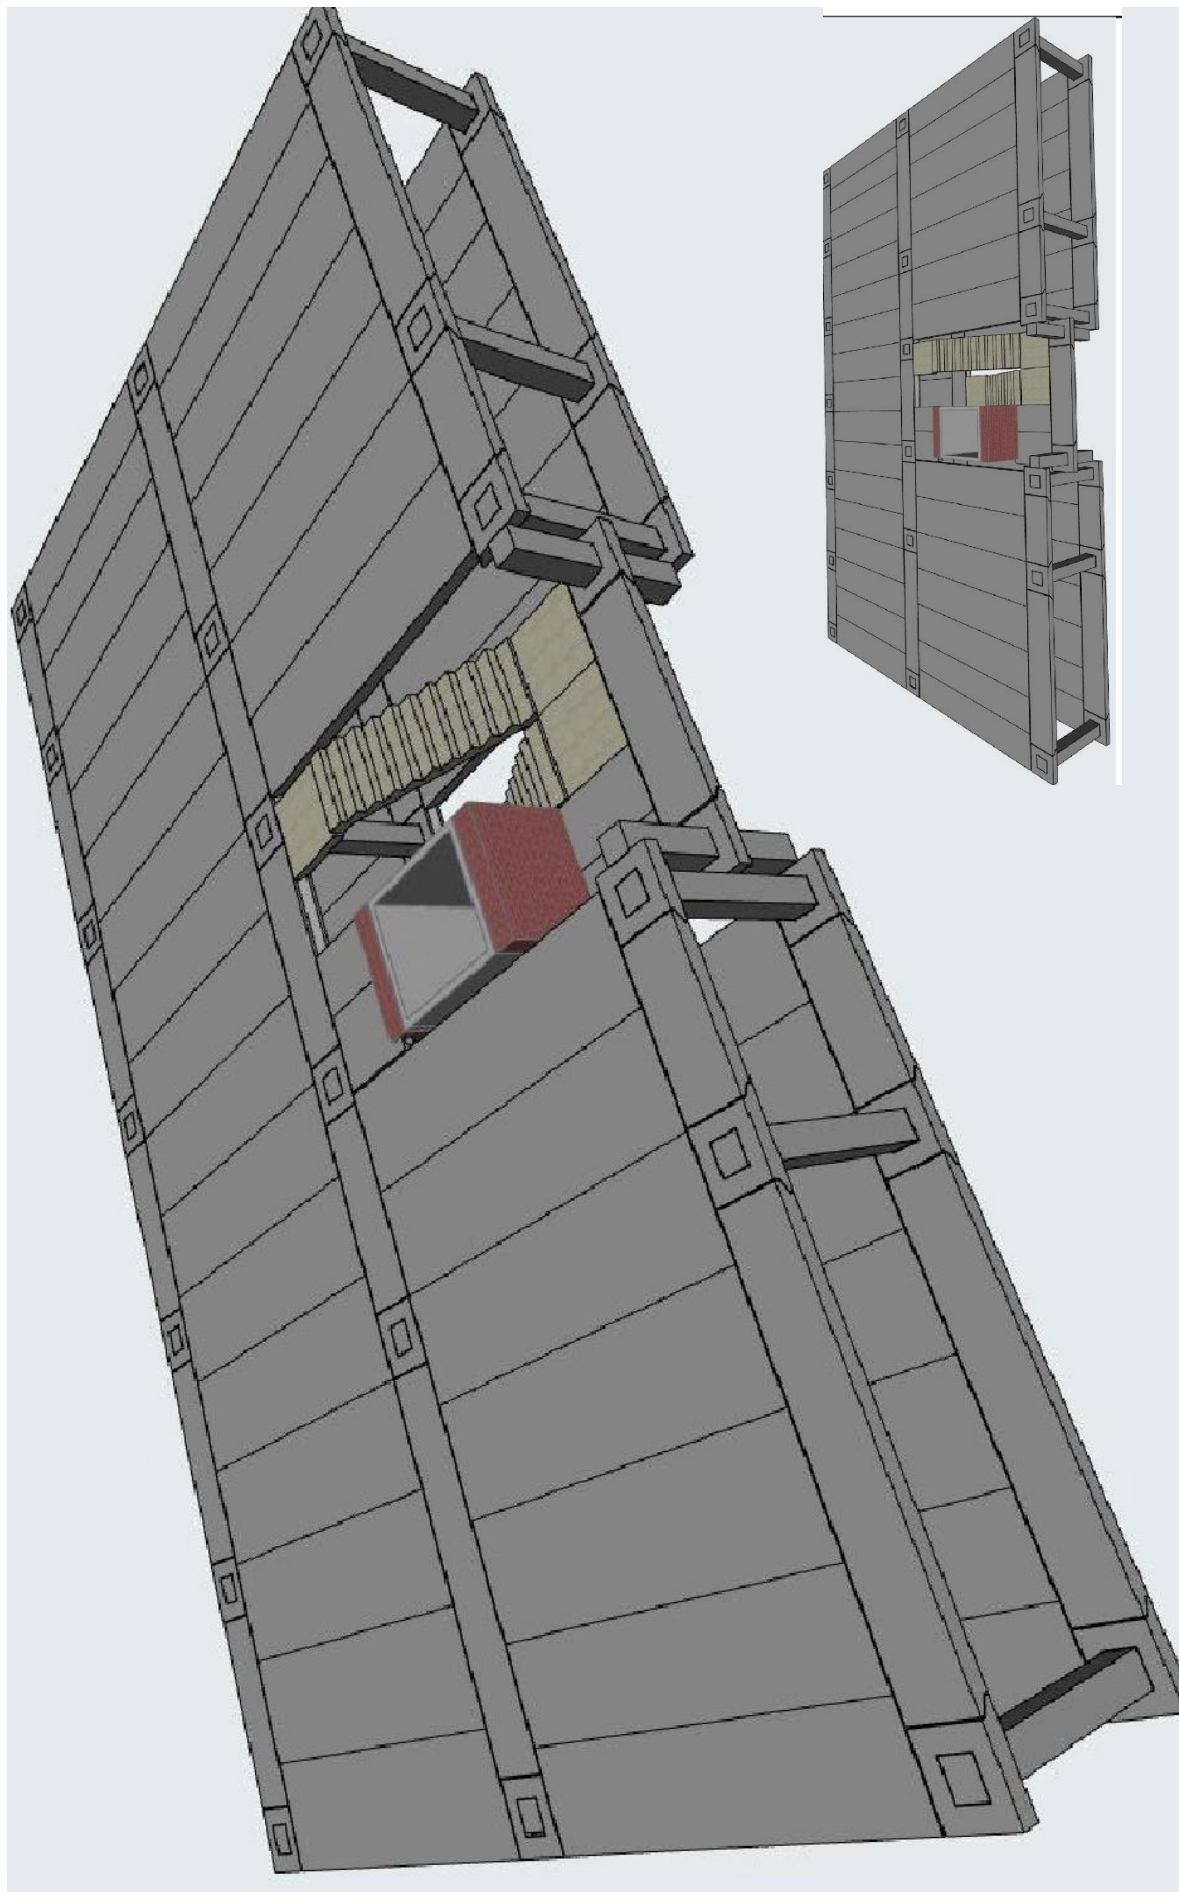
Візуалізація системи з використанням залізобетонного безбалкового перекриття із модифікованими круглопустотними плитами
